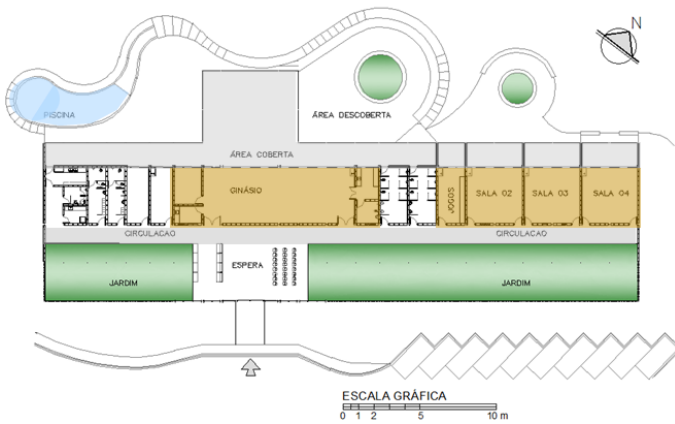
Planta geral do Ginásio Infantil (SARAH Fortaleza).
